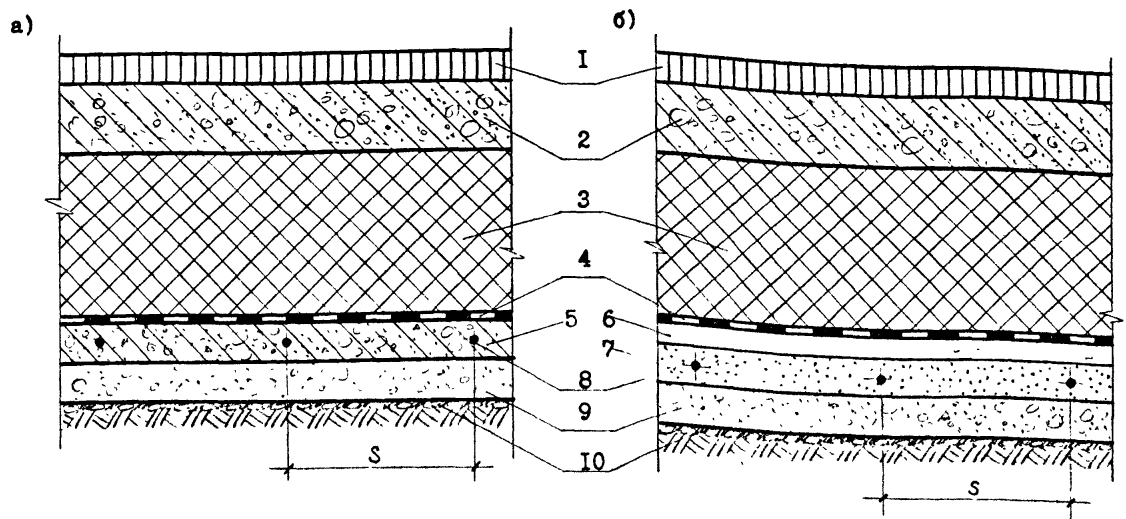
Конструктивная схема пола с греющим кабелем. а) кабель в плите; б) кабель в песке; 1 - покрытие пола; 2 - подстилающий слой; 3 - теплоизоляция; 4 - гидропарсизоляция; 5-обогревающая бетонная плита; 6 - стяжка из цементно-песчаного раствора; 7 - слой уплотненного песка; 8 - греющий кабель; 9 - бетонная подготовка; 10 - грунт основания, уплотненный щебнем или гравием.
